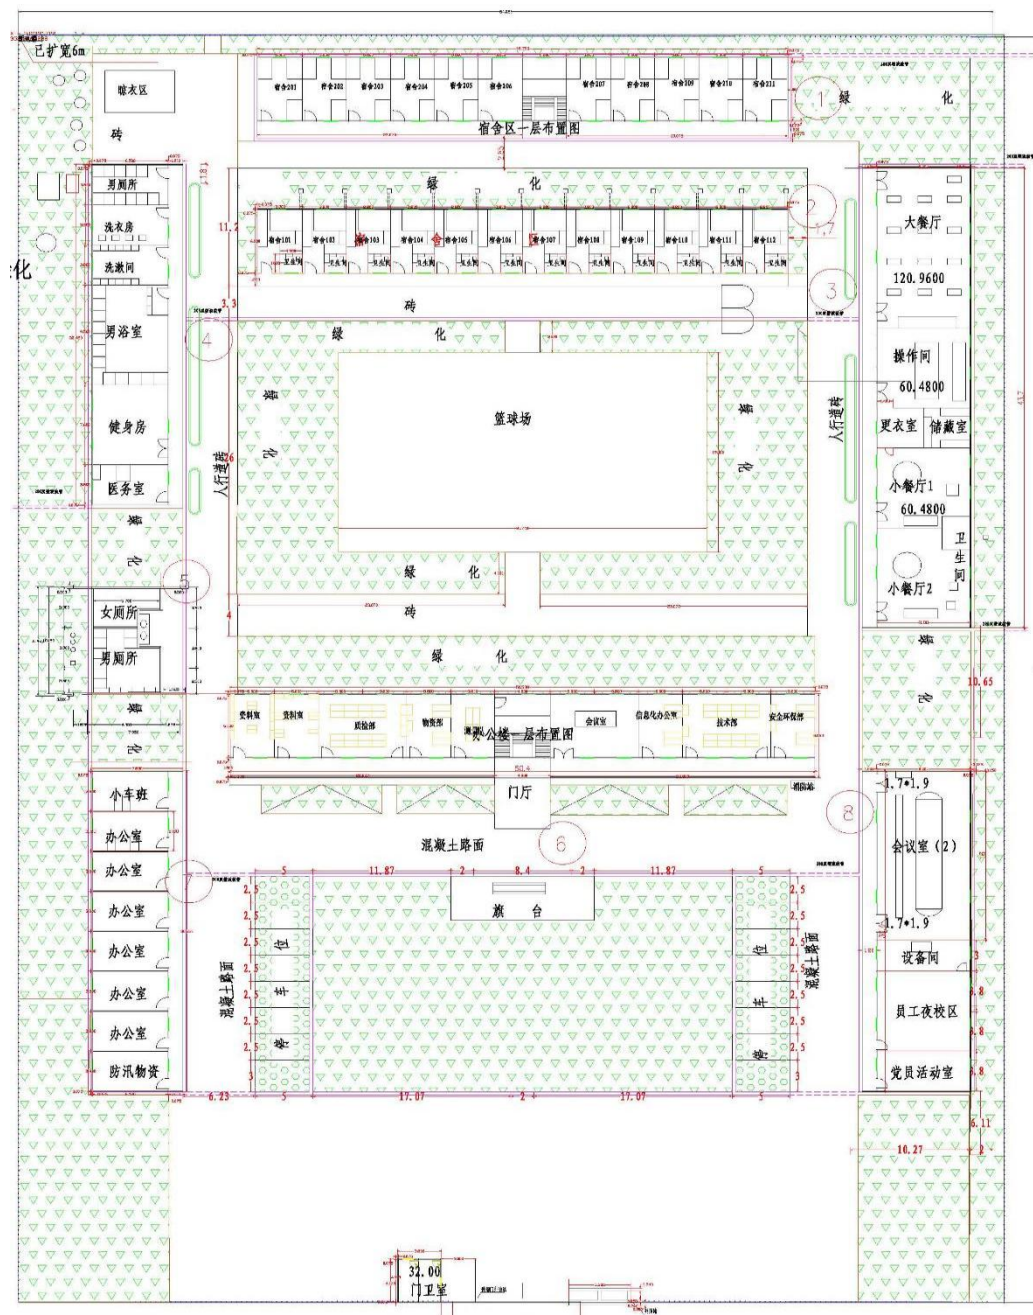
施工生活区（引江济淮一期工程）平面布置图
